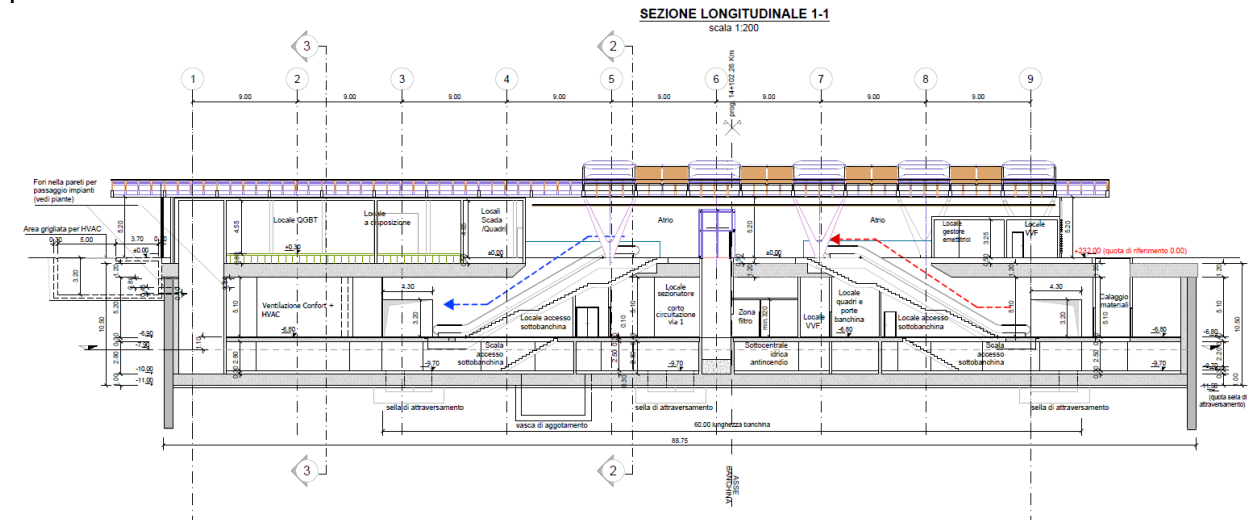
Stazione tipologica SL1- Sezione longitudinale
